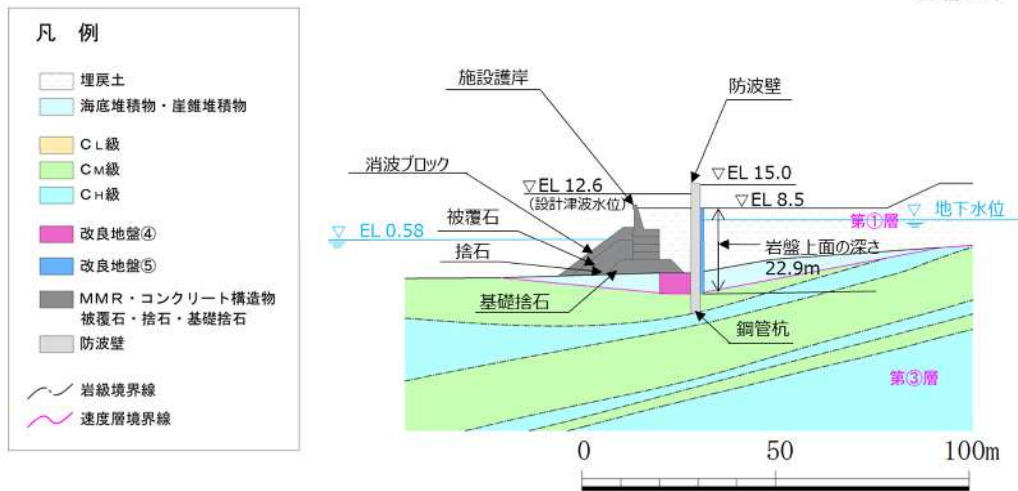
防波壁（多重鋼管杭式擁壁）の横断面図改良地盤部（②-②断面）
